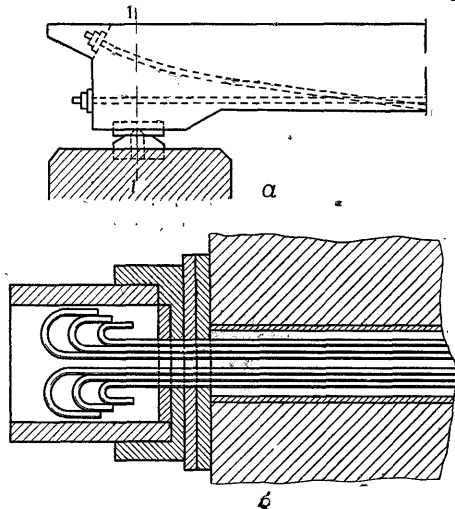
Подрывание предварительно напряженной железобетонной балки:
